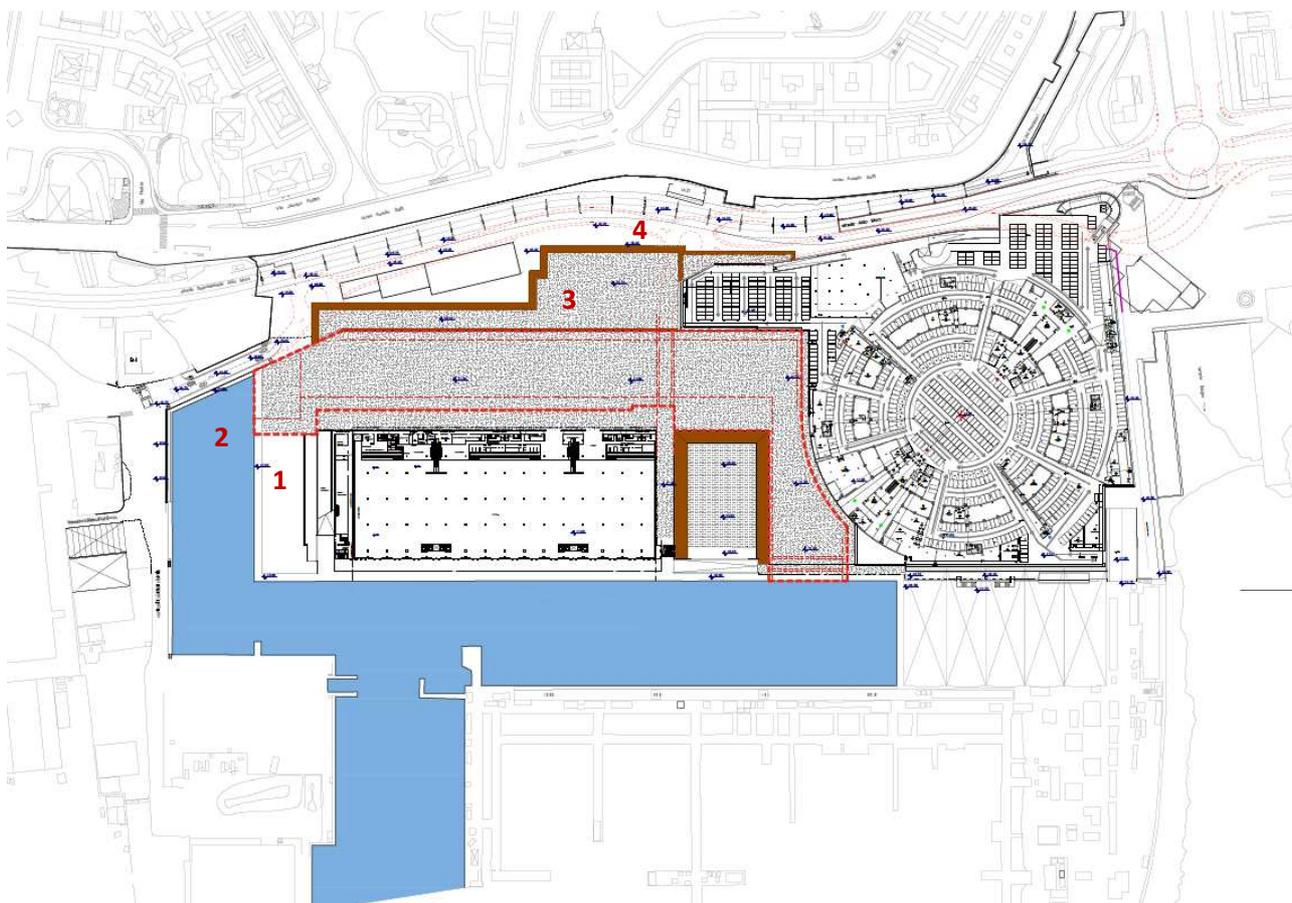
Stato di fatto dell'area ad avvio interventi di realizzazione canali (stralcio tavola T002-D-Ar del Progetto Definitivo).
